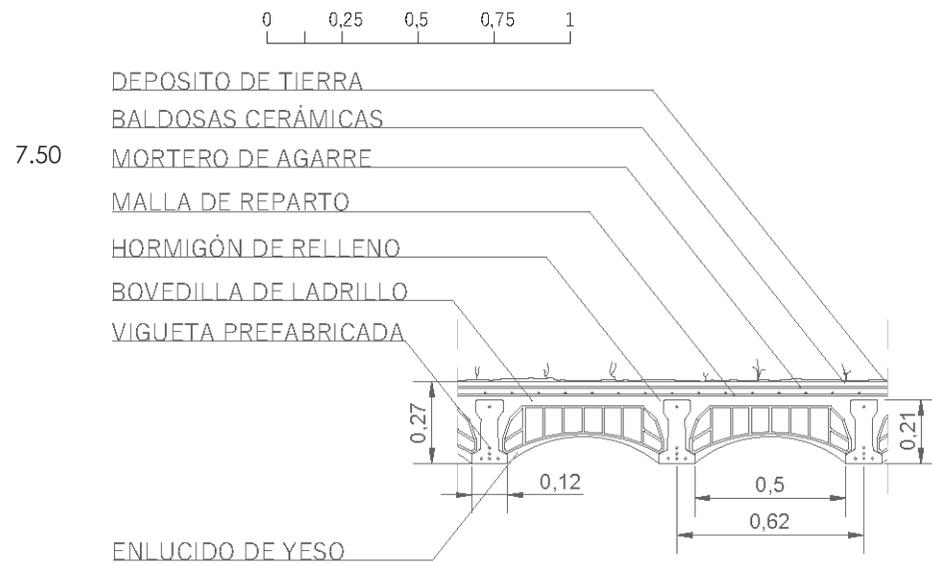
Detalle constructivo de la cubierta TIPO 2.
